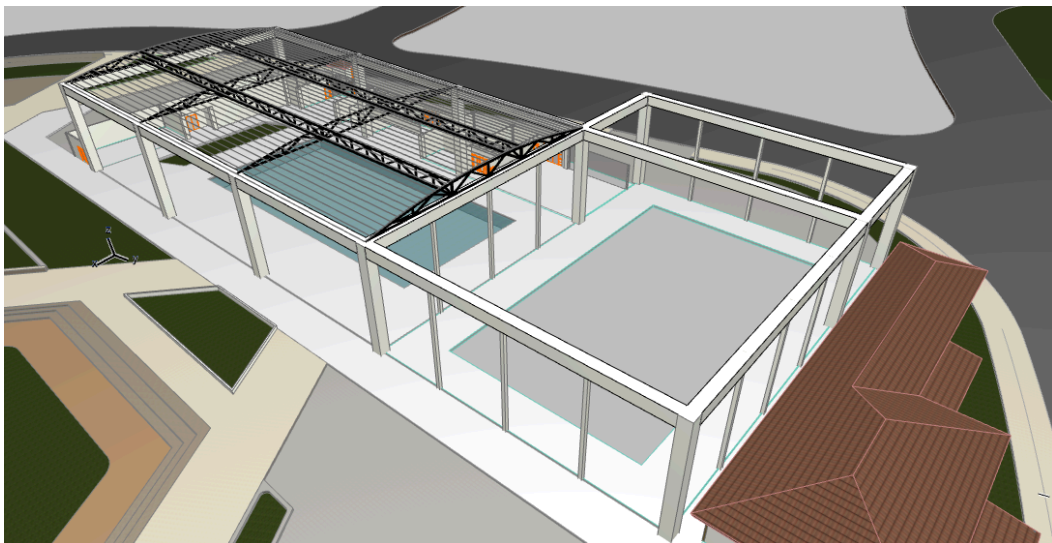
Suasana Bagian Dalam Ruang Bangunan Kolam Renang
